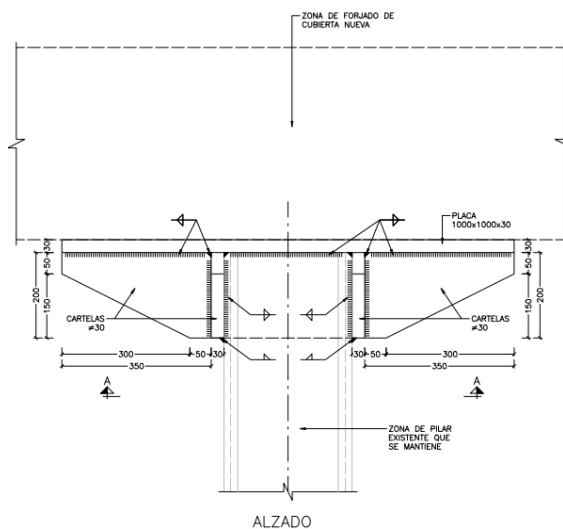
Detalle de capitel metálico en pilares de forjados reconstruidos
